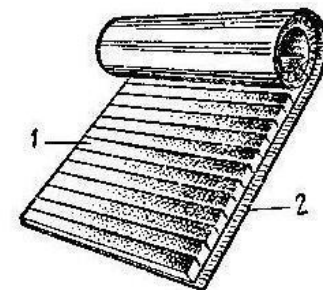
Минераловатный вертикально-слоистый мат: 1 — минераловатные полосы, 2 — защитно-покровный материал
